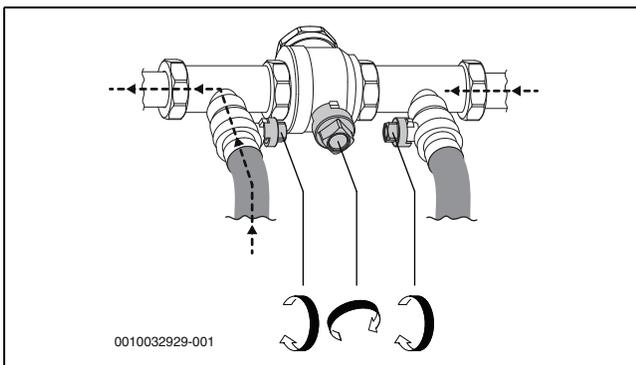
Befülleinrichtung in Druckerhöhungsposition
